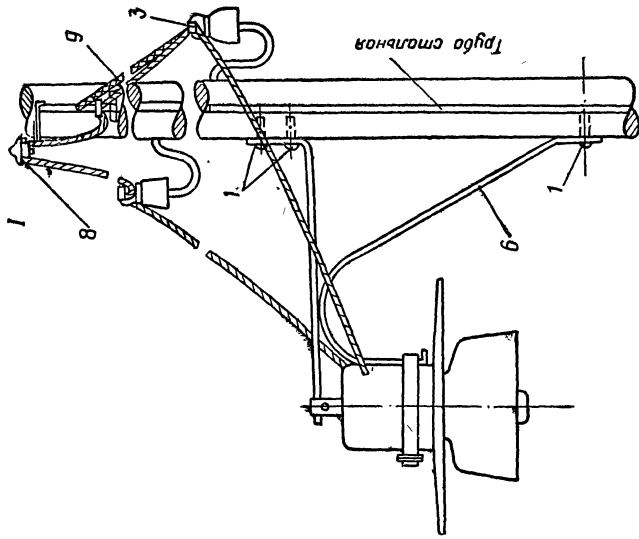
Установка светильников наружного освещения на опоре ВЛ
